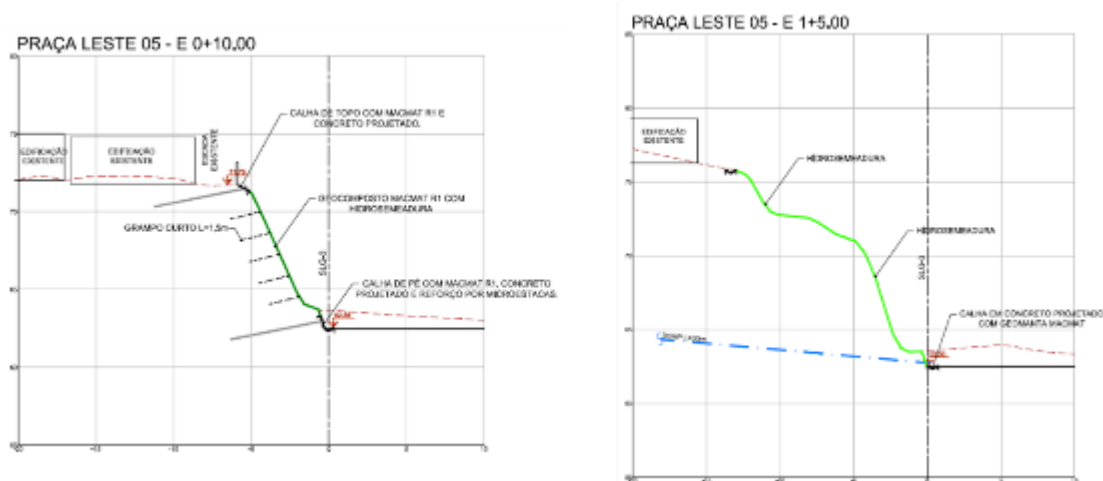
Exemplos de soluções verdes adotados no projeto executivo (anexo 03)
